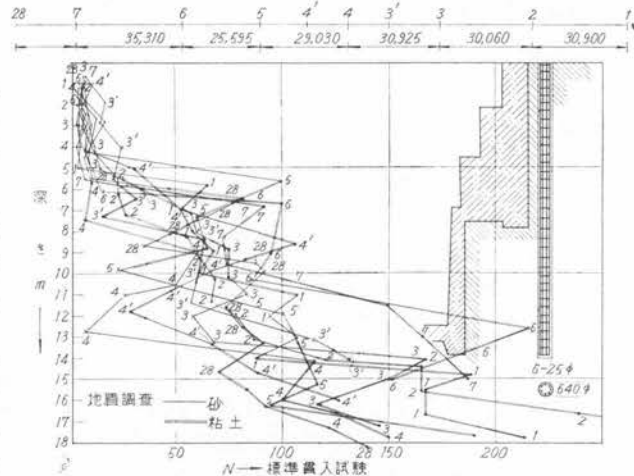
直径 640 mm, 長さ 14.00 m くい施工図
